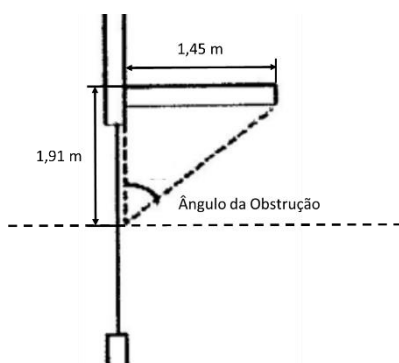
Ângulo de Obstrução dos Elementos Horizontais Sobrejacentes aos Envidraçados do Piso Longo Bloco com Gabinetes
